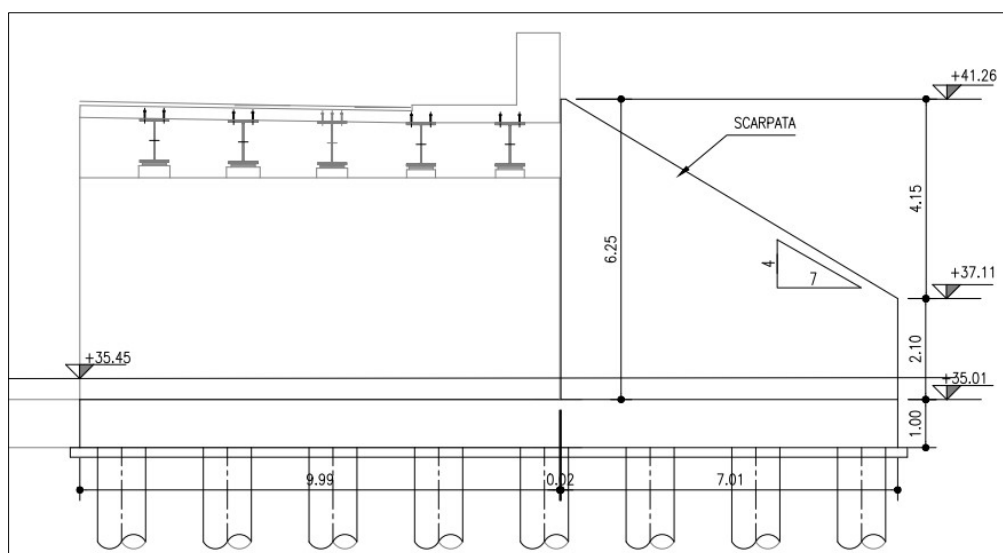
Prospetto del muro d'ala lato Bologna – Allargamento Nord
